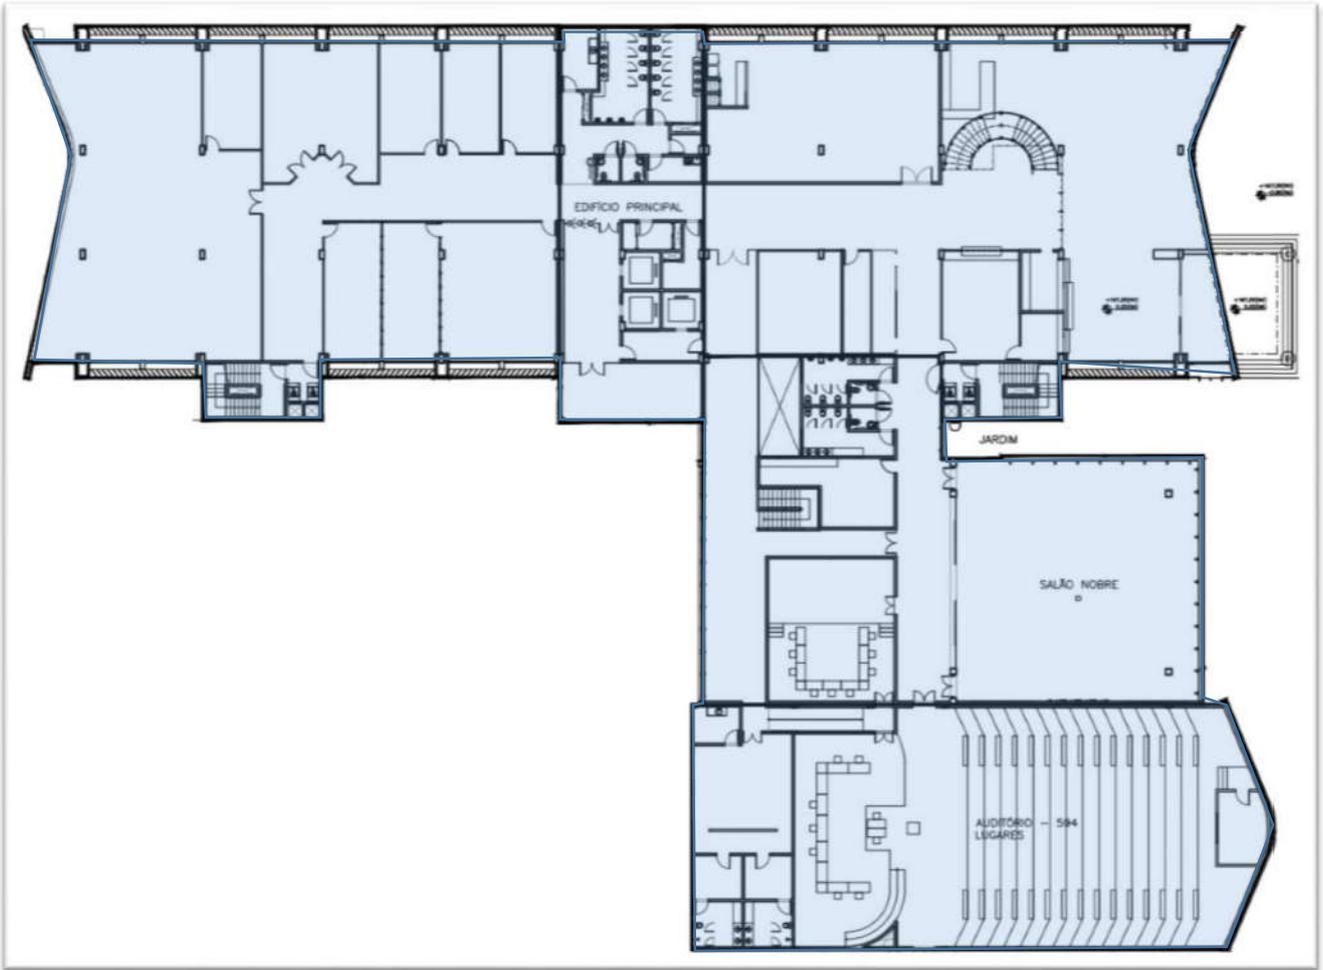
Planta Baixa Térreo SEDE TRE/AC
